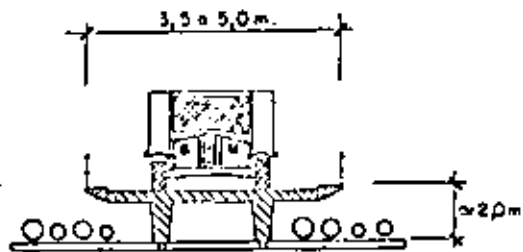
SECCION TIPICA ACCESO PRINCIPAL
